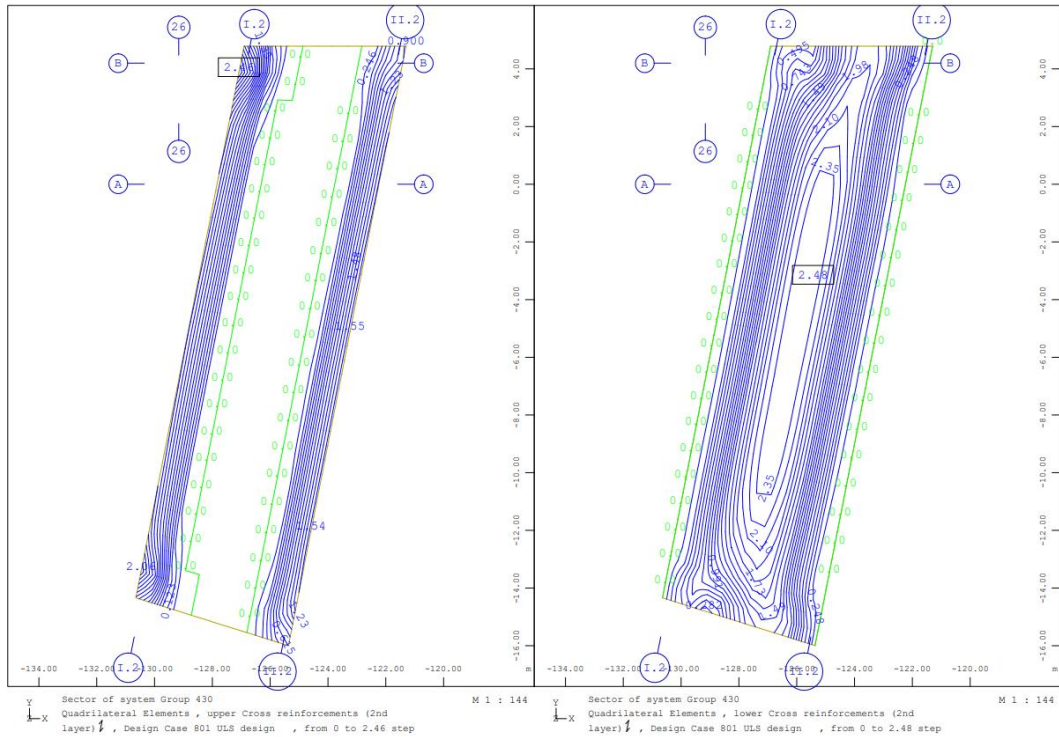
Armadura secundária na face superior (esq.) e inferior (dir.) – laje de cobertura – túnel - ELU
